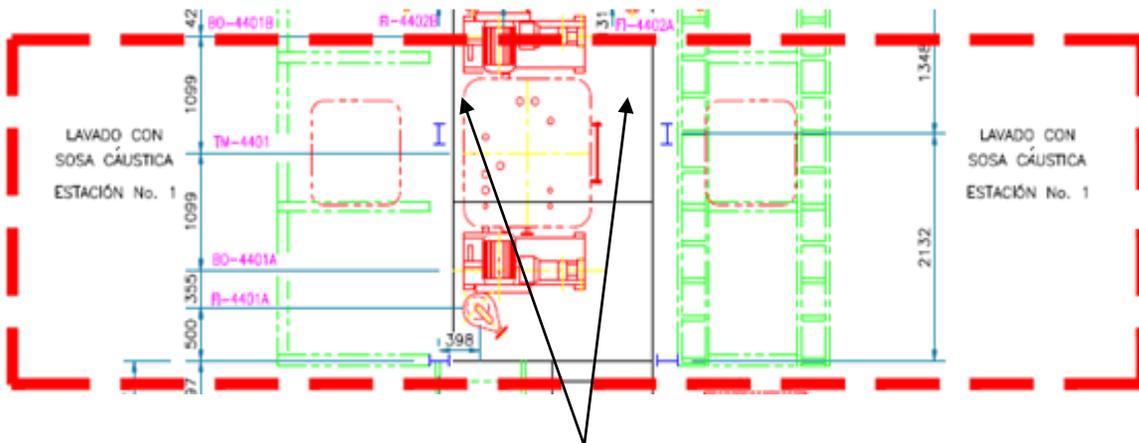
Ubicación de los scrubbers en la planta lavado de totes
